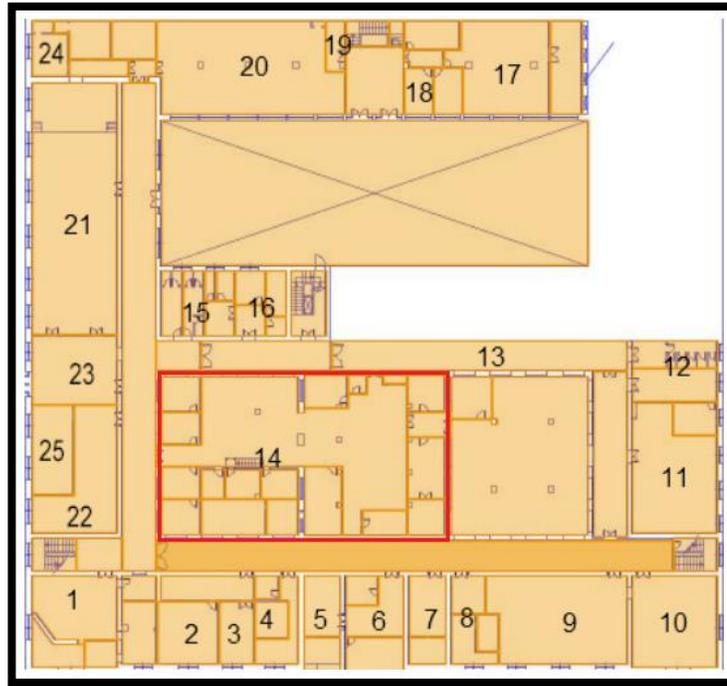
Plano de la segunda planta de la escuela de Ingeniería de Minas, Energía y Materiales de Oviedo, Ubicación del Laboratorio de Metalurgia (Mineralurgia) en el plano (UNIOVI, s.f.).
